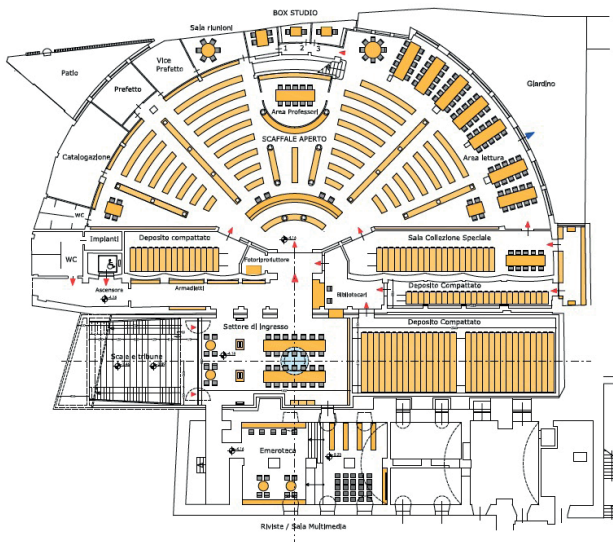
Planimetria della biblioteca (in giallo lo schema di arredo)
